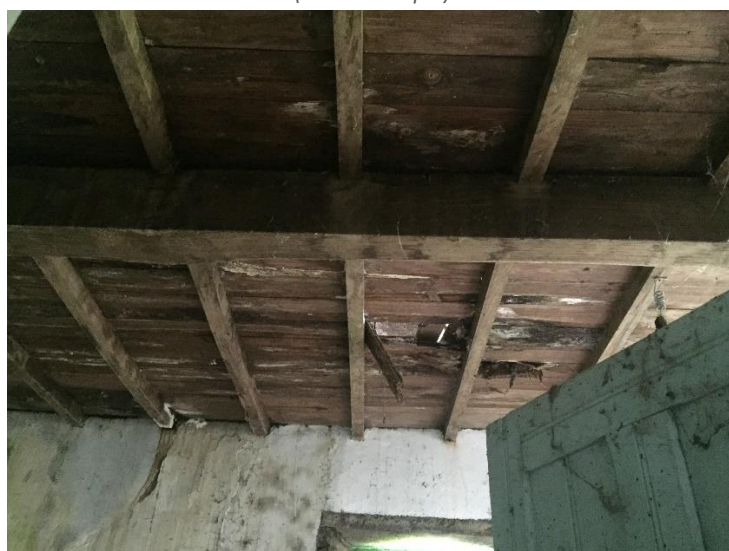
Vista interior del comedor en planta alta. (Fuente: Propia)
